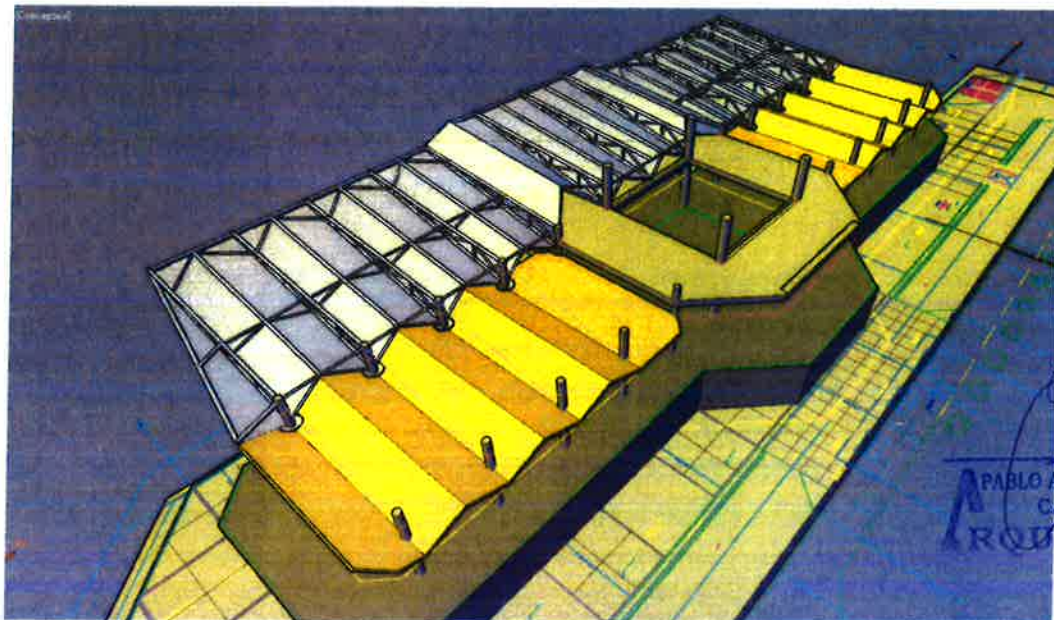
Propuesta de cobertura tensionada en terraza lado oeste.
